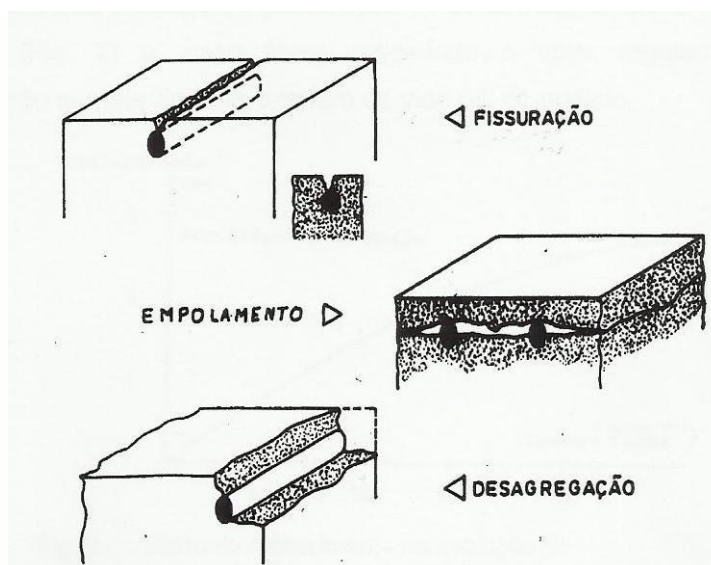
Tipos de degradação do betão originadas pela corrosão das armaduras observadas nos edifícios
